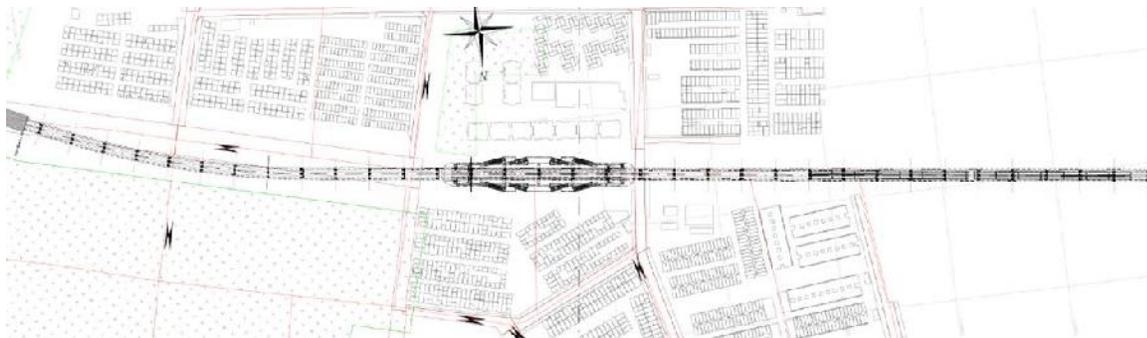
Planta del viaducto elevado y planteamiento de pilas.
